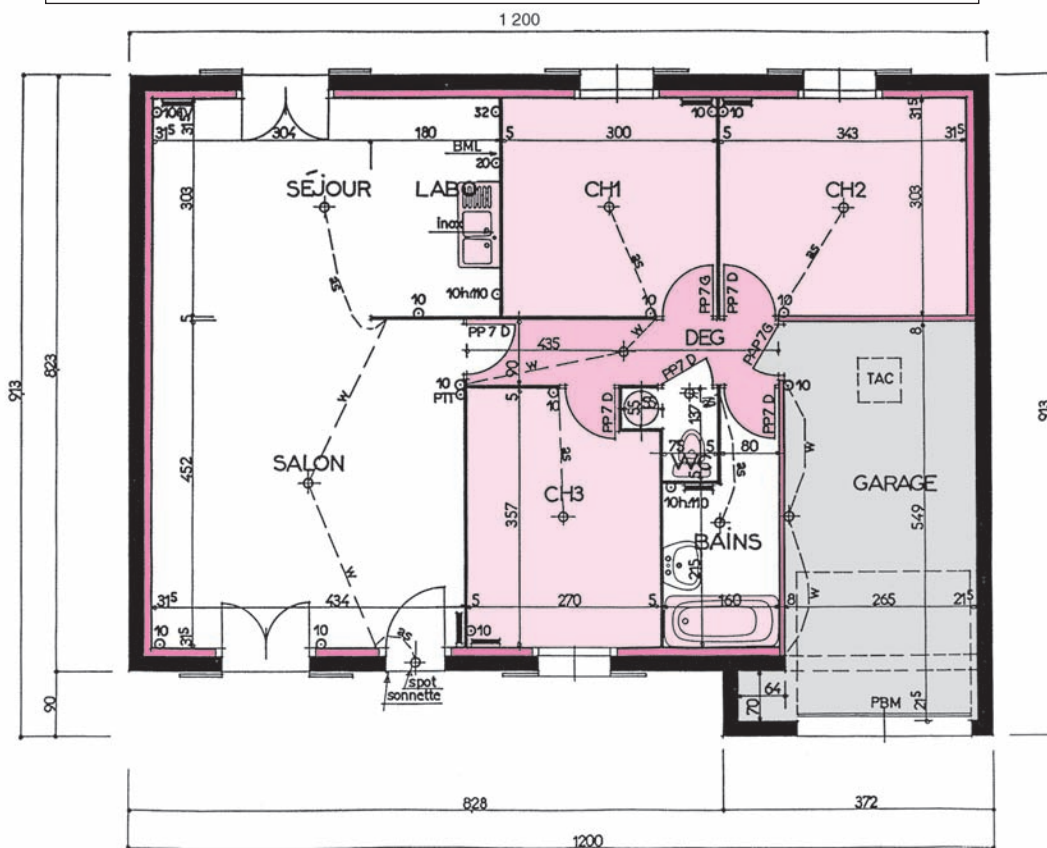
Plan du rez-de-chaussée présenté dans un dossier de demande de PC
